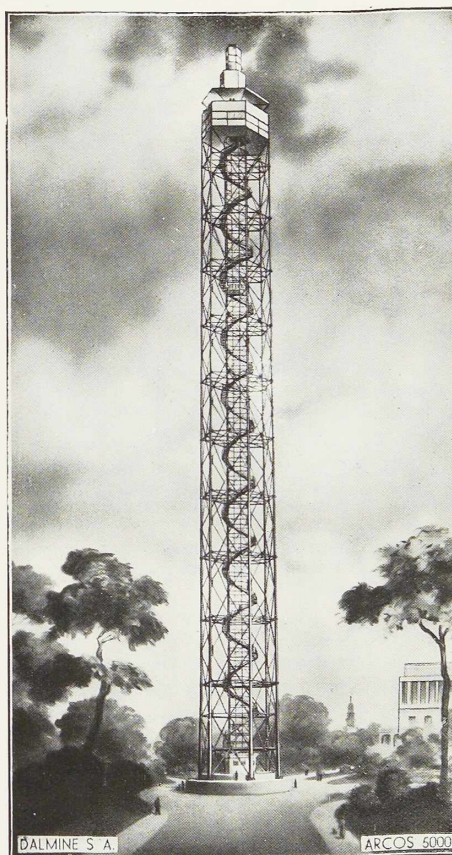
Vue de la tour Littoria à Milan. La tour a 106,60 m. de hauteur et est construite en tubes assemblés par soudure. (Cliché Arcos.)
